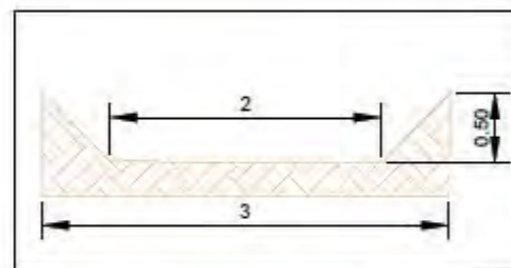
Plan principe d'assainissement (5/6) (source : AVP, 2024)
